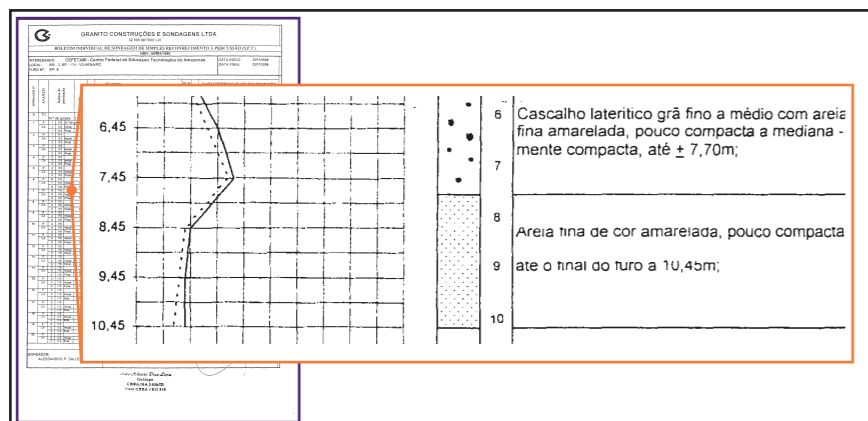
Adaptado de Análise de Solo IFRO Campus Vilhena. DPLAD (2008)
